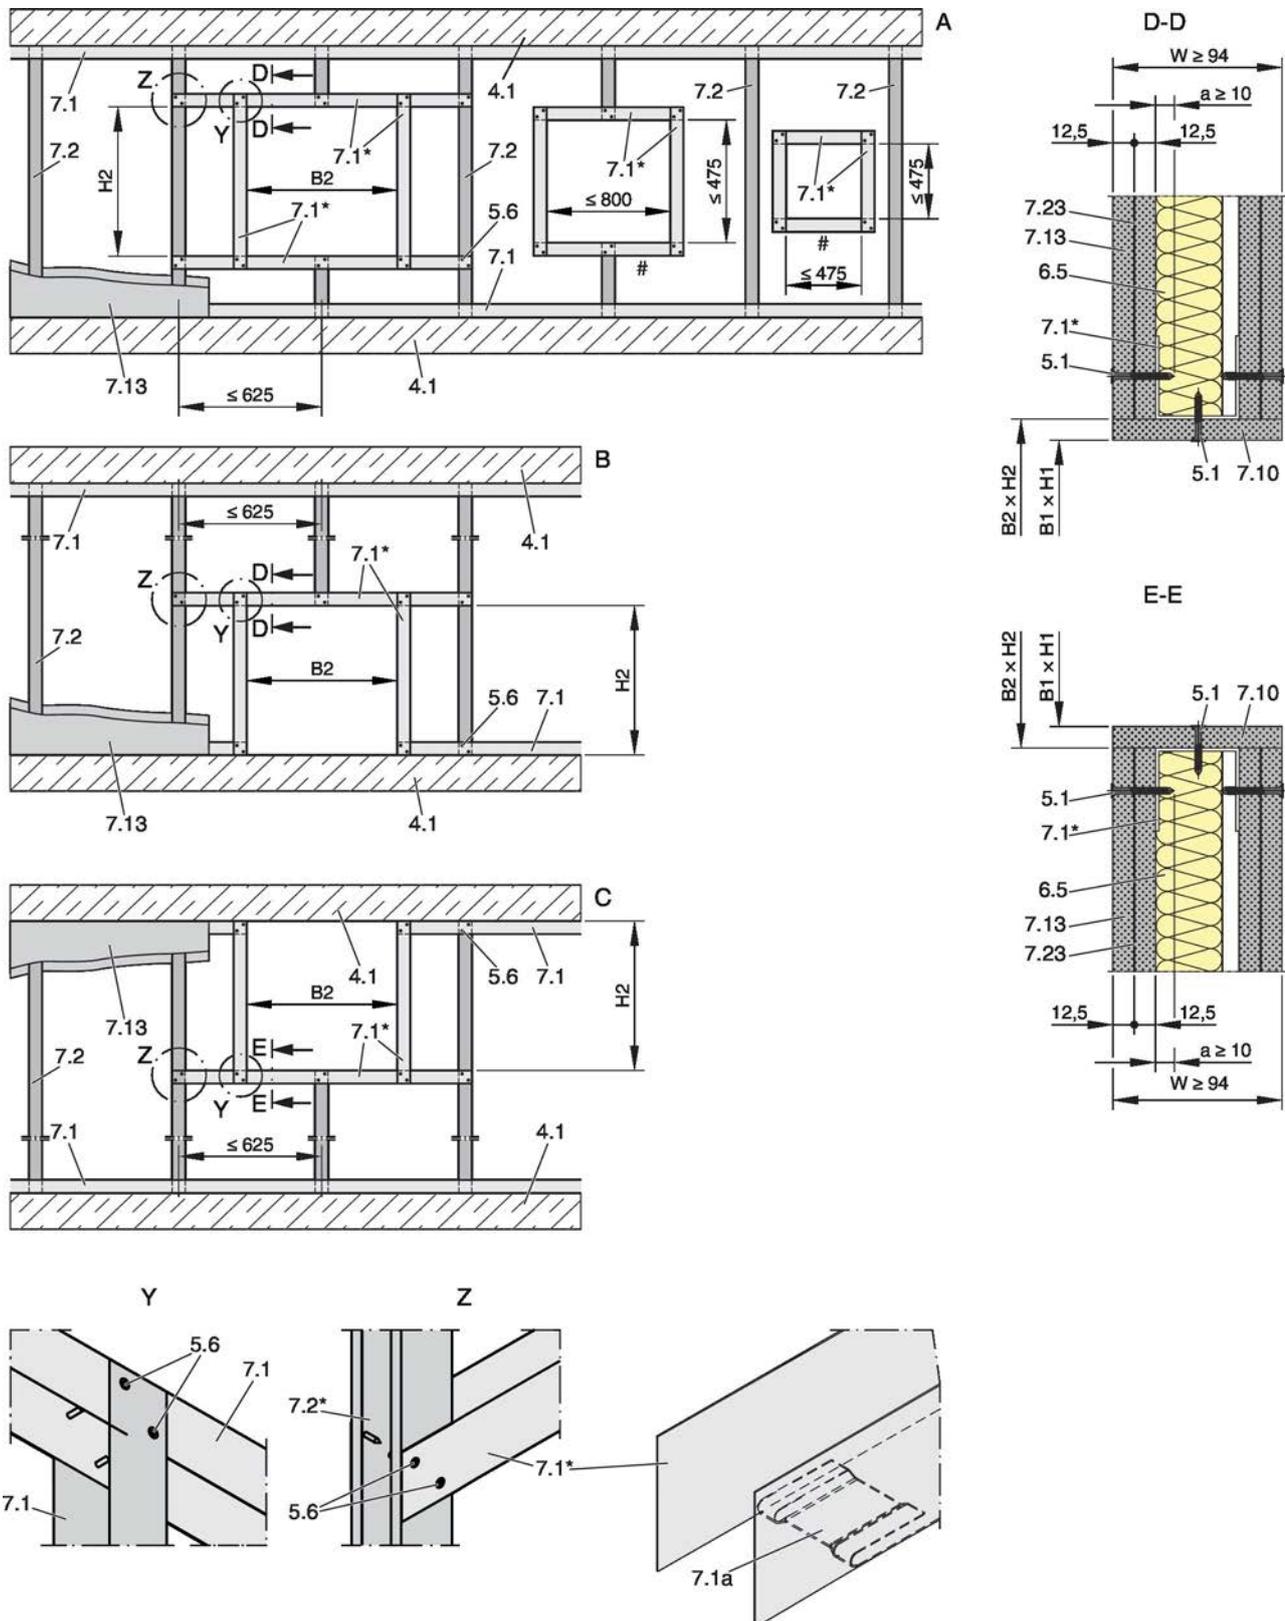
Tabiques divisorios ligeros con estructura de soporte metálica y revestimiento por un lado
